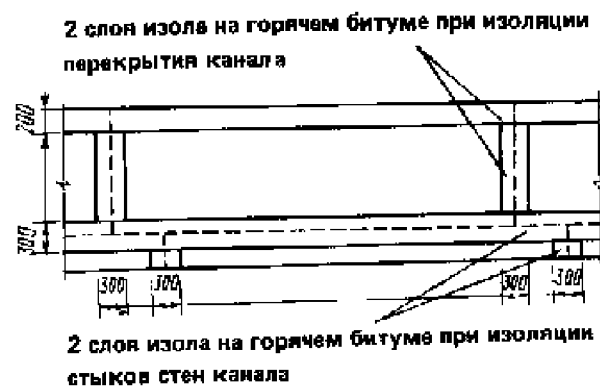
Гидроизоляция канала при высоком уровне грунтовых вод
